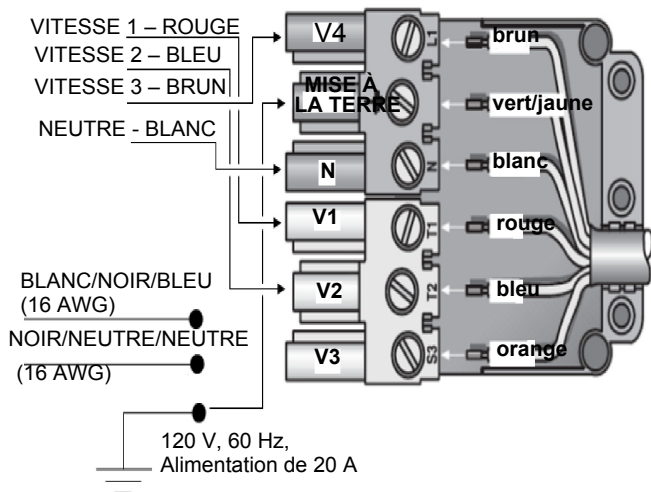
Câblage de hotte avec un ventilateur de conduit
